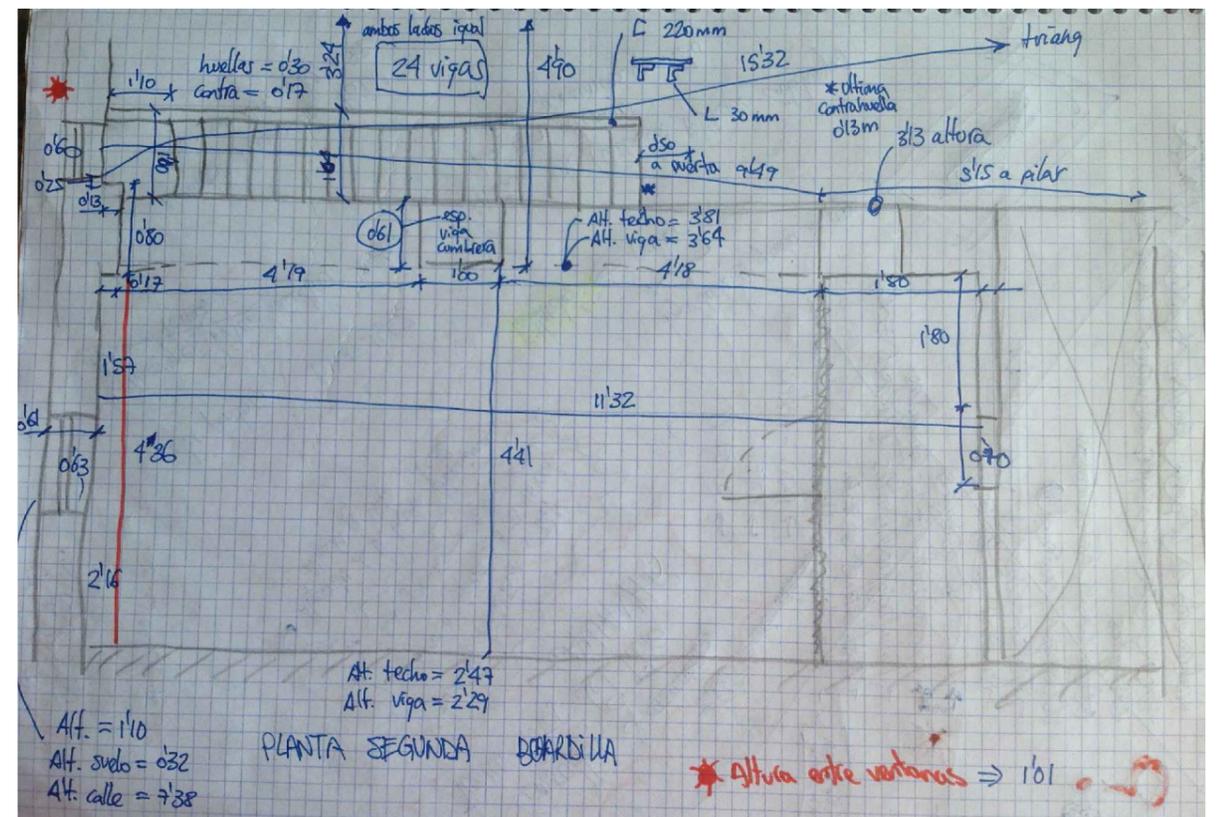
Planta segunda. 2014. Fuente: elaboración propia.
